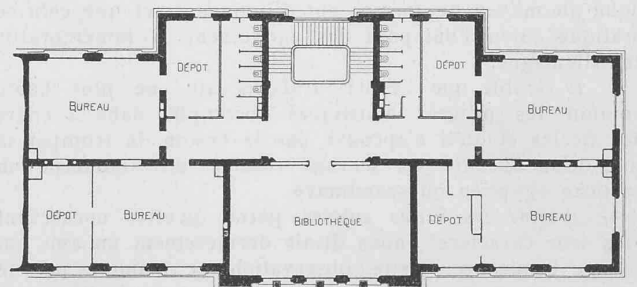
Plan du premier étage. — Echelle 1 : 500.
